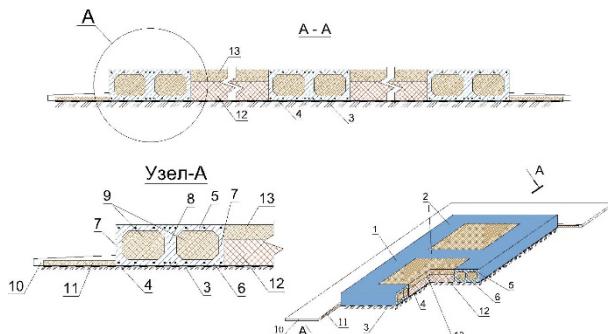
Ленточные плитно-рамные фундаменты, возводимые на просадочных грунтах: 1,2- ленточный плитно-рамный фундамент; 3-выровненное основание; 4-гидроизоляционный слой; 5-верхняя железобетонные плиты; 6-нижняя железобетонные плиты; 7-боковое ребро; 8-среднее ребро; 9- плитный утеплитель; 10- отмостка; 11- плитный утеплитель; 12 – земляная масса (грнт); 13- плитный утеплитель
